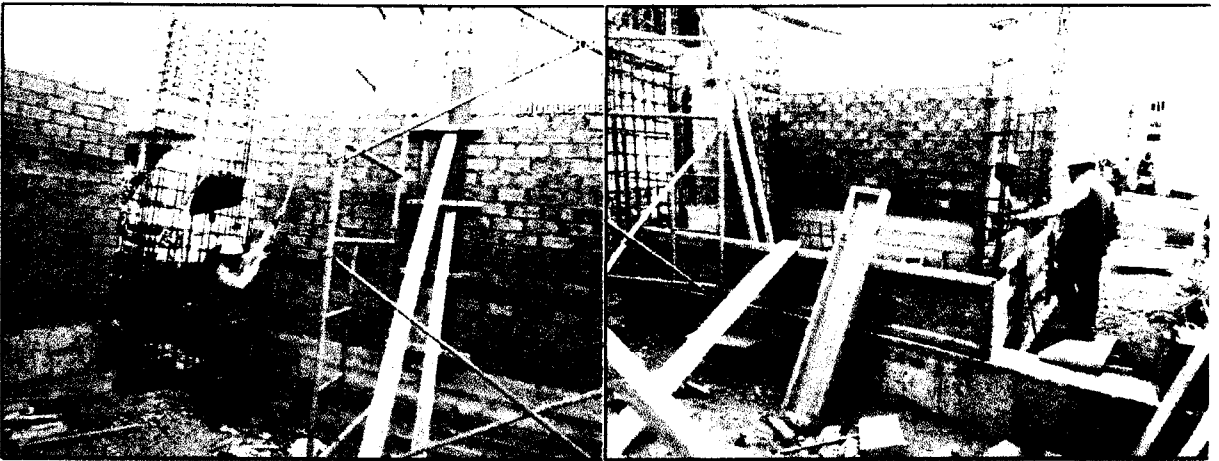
y 18: vista de los trabajos de construcción de muros de ladrillo y continuación de de encofrado de sobrecimiento así como colocación de columnetas.
